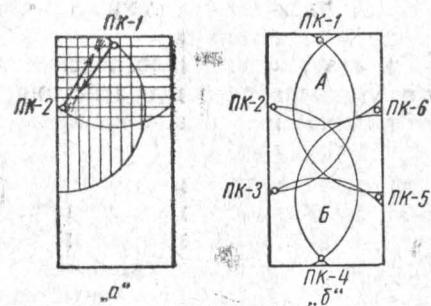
Размещение пожарных кранов при расчете на две струи.
